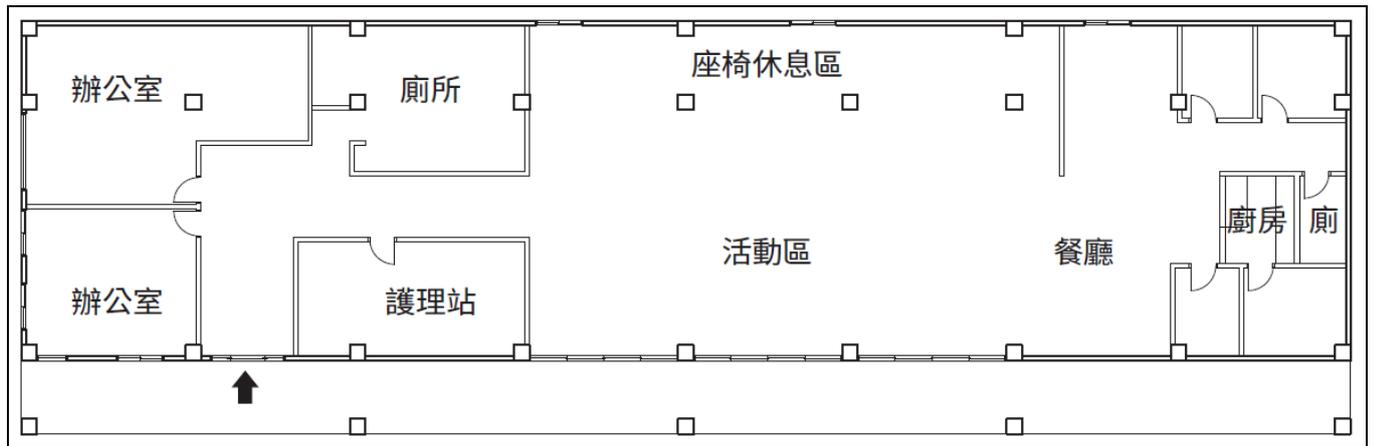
怡親護理之家鼓山日間照顧中心平面圖
